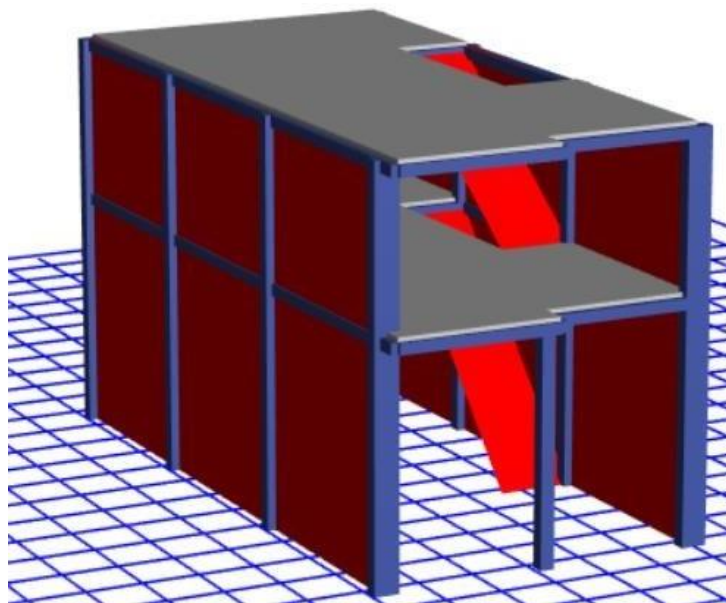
Modelamiento en Etabs de la vivienda autoconstruida 1
